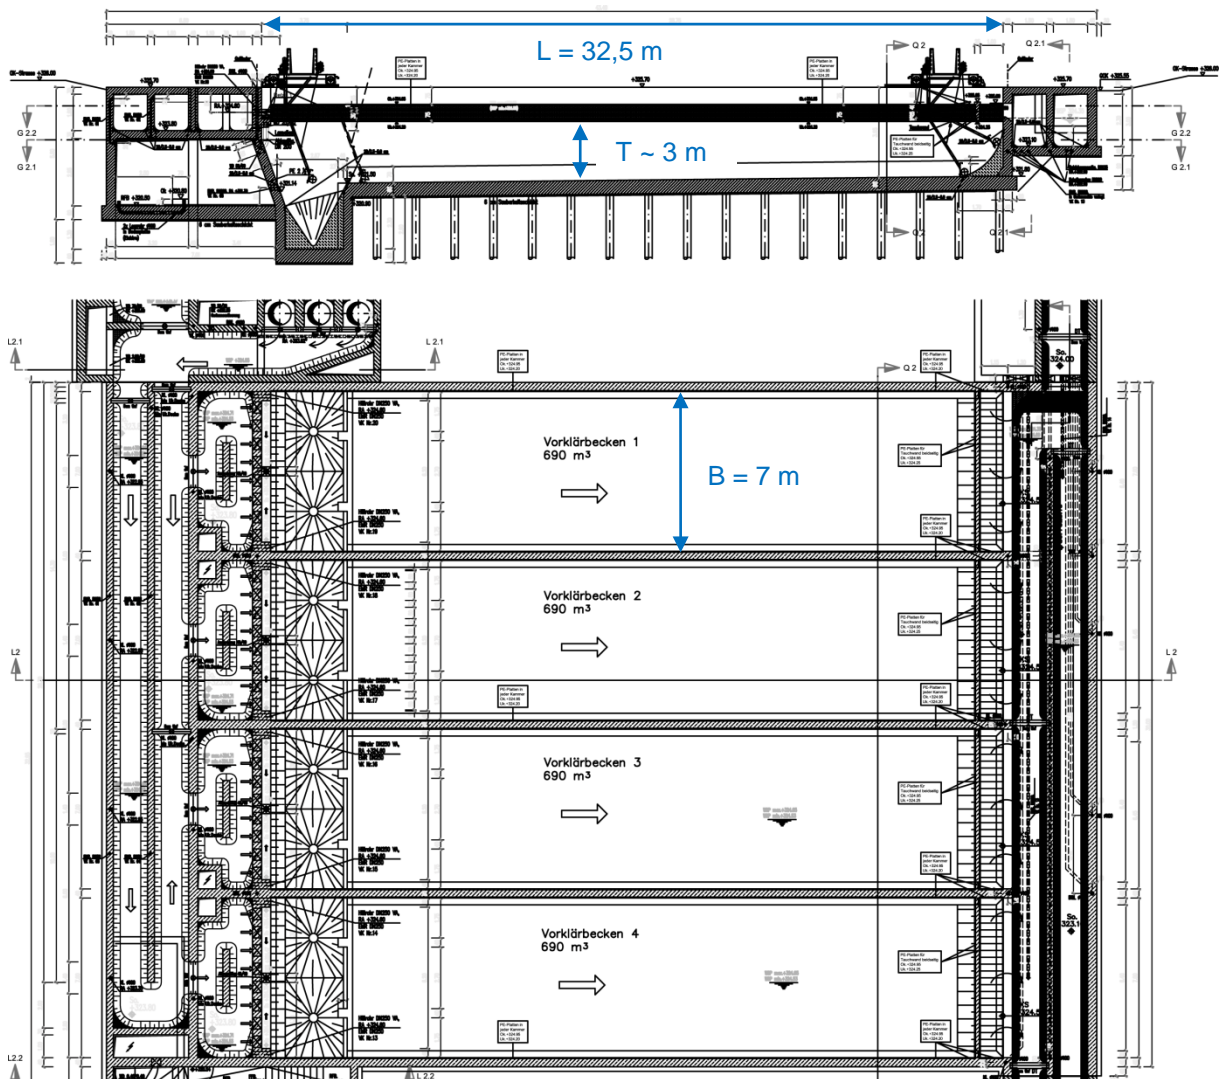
Grundriss und Längsschnitt der Vorklärbecken der Kläranlage der Stadt Graz
